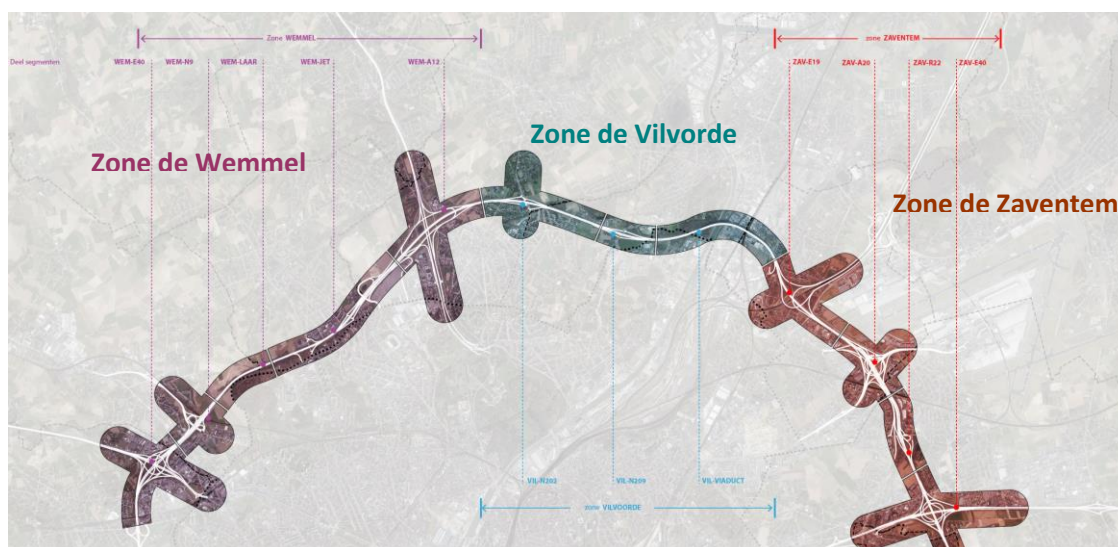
Division en 3 zones (Wemmel, Vilvorde et Zaventem)
